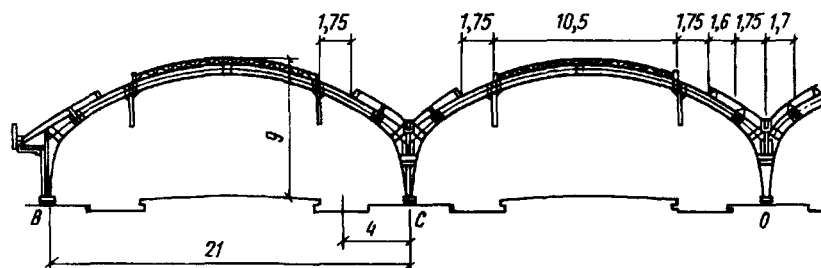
Многопролетная арка перекрытия вокзальных перронов
